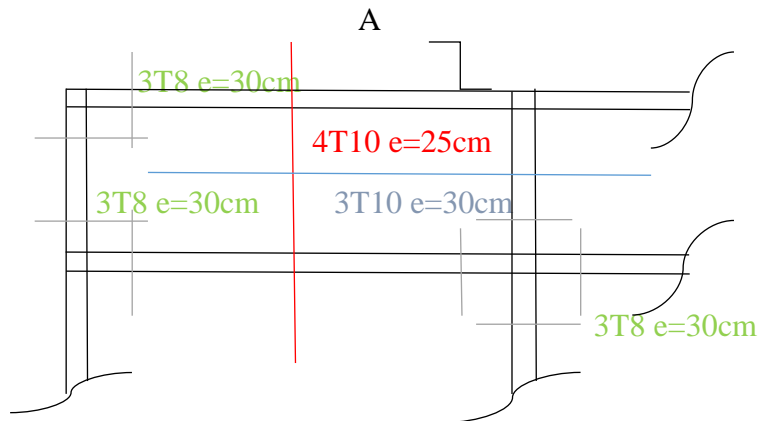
Schéma de ferrailage dalle pleine centre commercial
